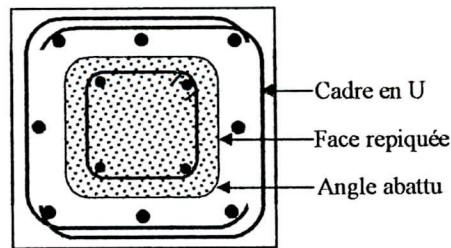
Renforcement d'un poteau par chemisage [2]
